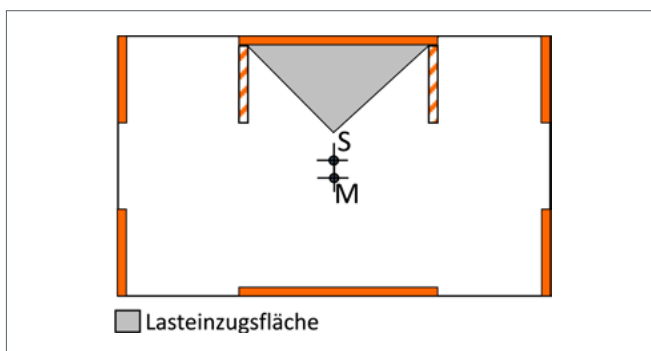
Grundriss mit kurzen vertikal tragenden Wänden im Bereich schubbeanspruchter Wände
